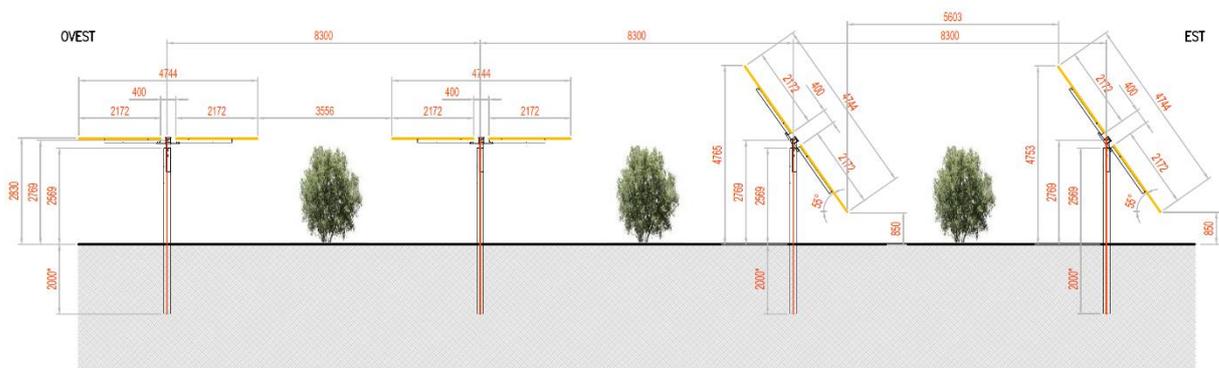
Tipologico – Vista Planimetrica dell’impianto Olivicolo
